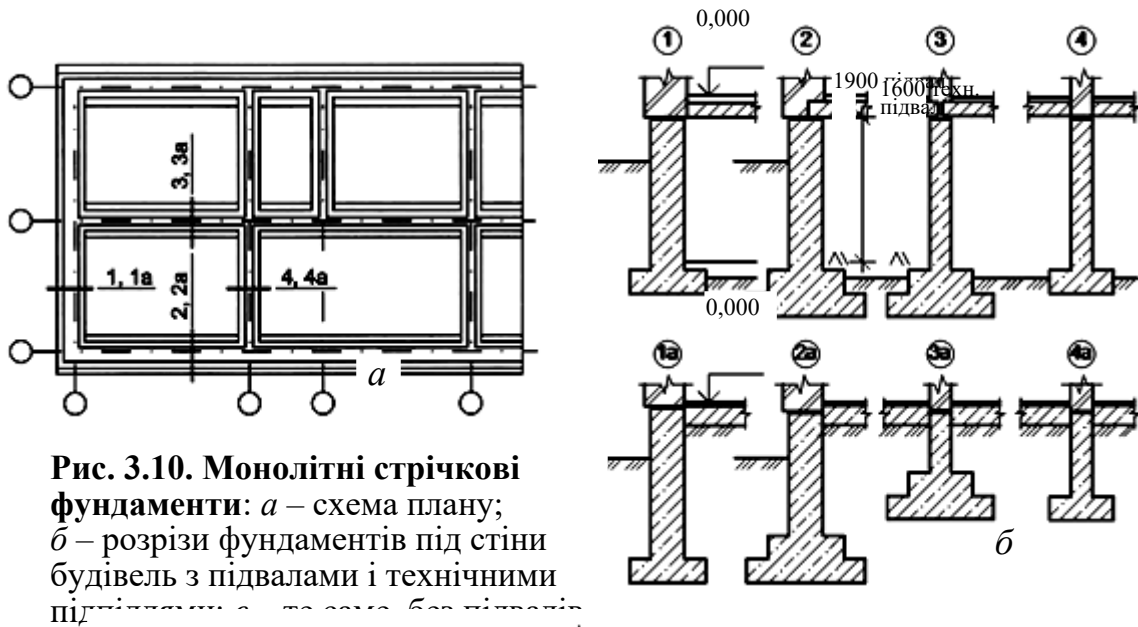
Монолітні стрічкові фундаменти: *a* – схема плану; *б* – розрізи фундаментів під стіни будівель з підвалами і технічними підповерхами.
